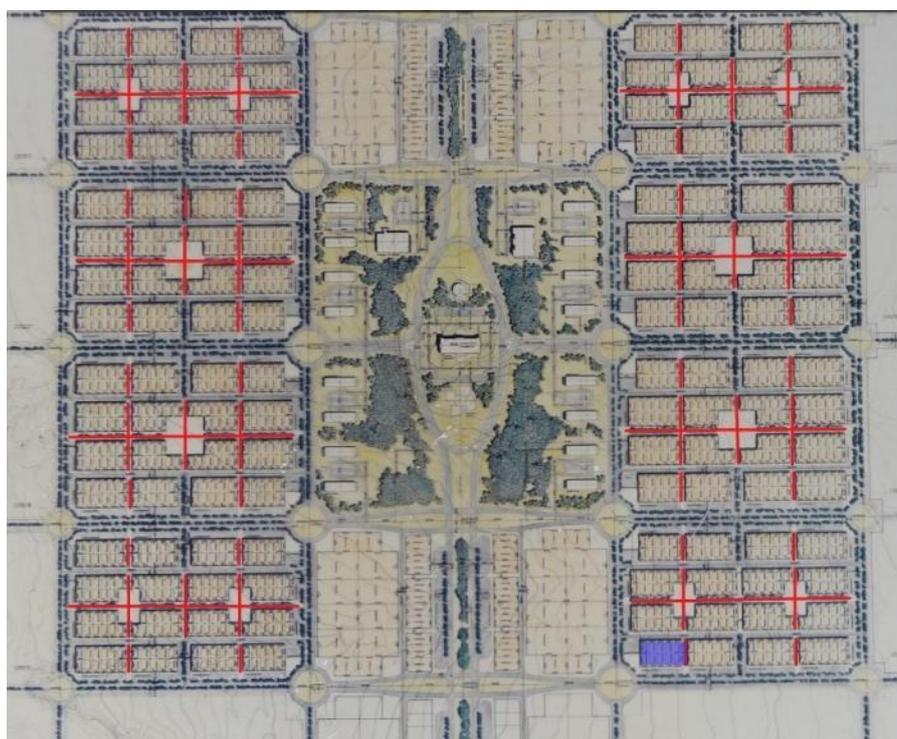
Área de Comércio e Serviço Central com destaque em vermelho para as pretendidas ruas de pedestres não executadas e em azul a galeria Wilson Vaz. Fonte: Fundação Cultural adaptado pelo autor (2020)
